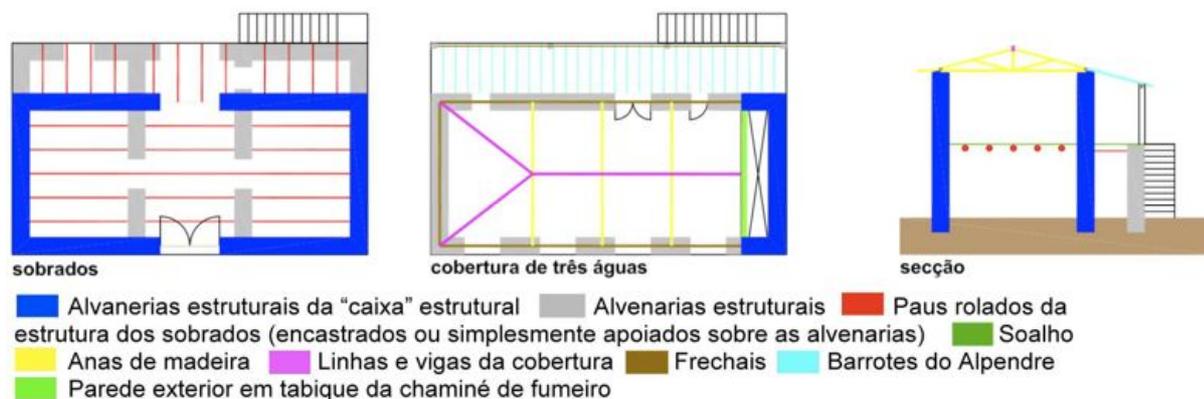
Esquema estrutural tipo dos elementos horizontais de travamento
